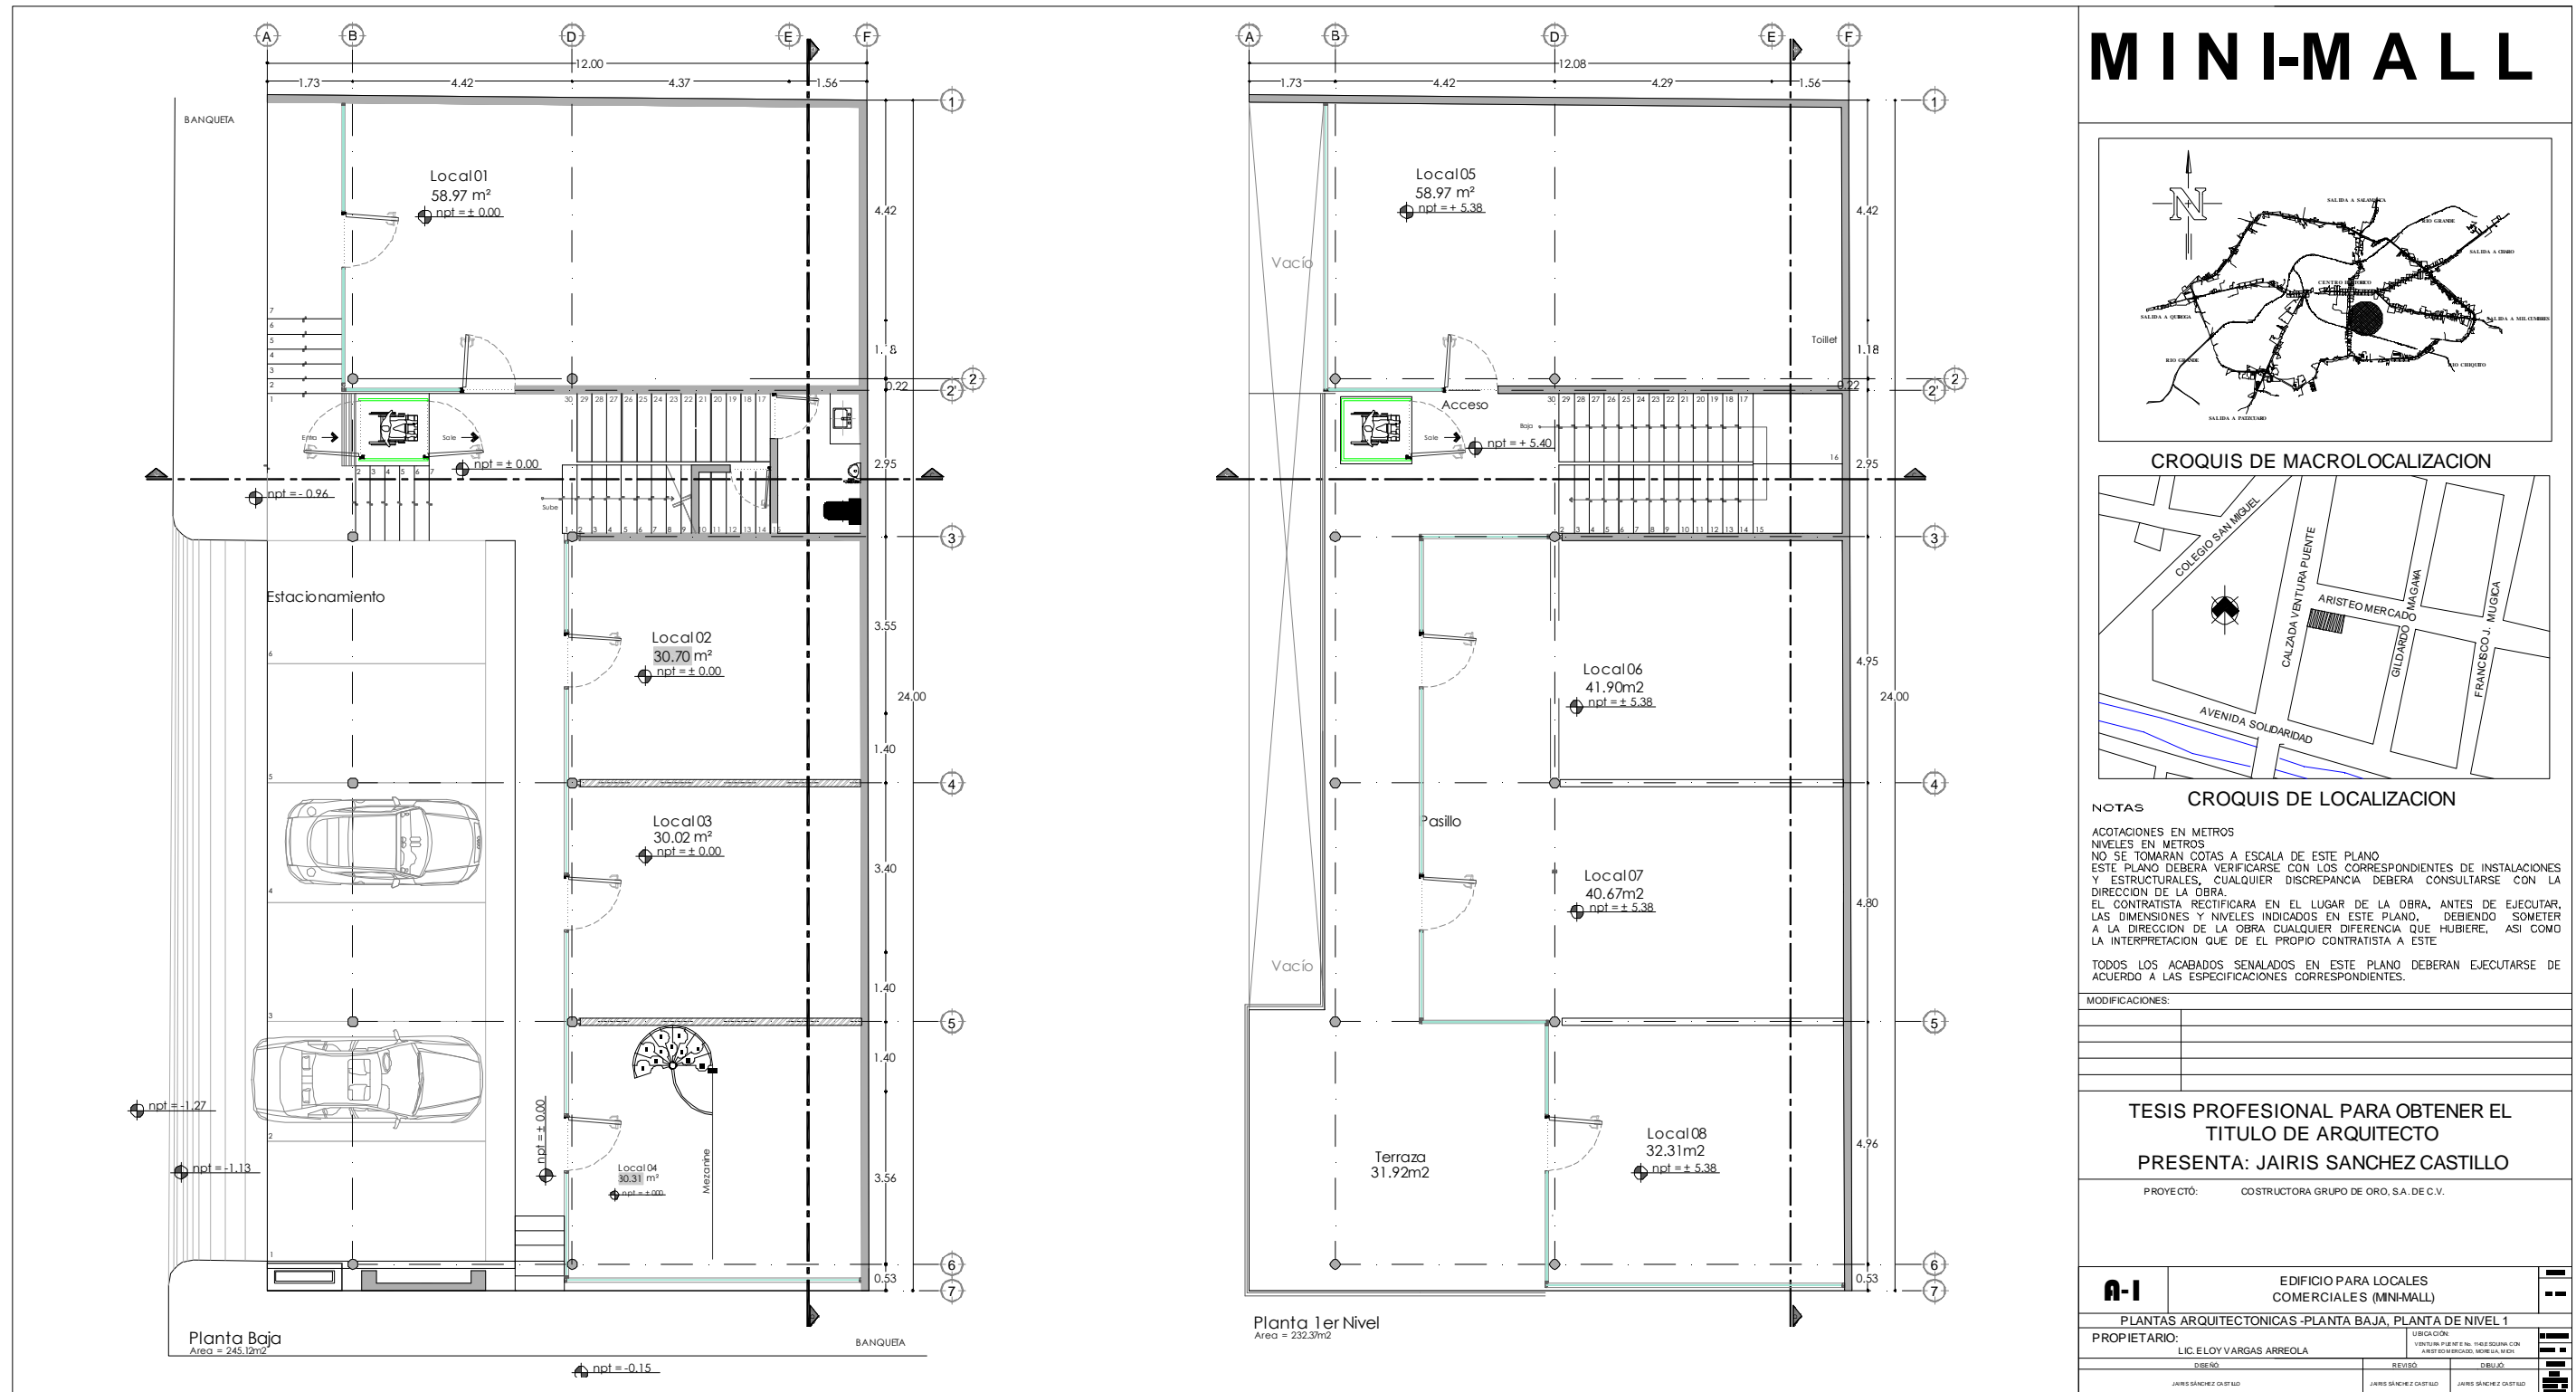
Planta Arquitectónica de Conjunto. Plano A-1. Proyecto Arquitectónico Locales Comerciales "Mini-Mall."
